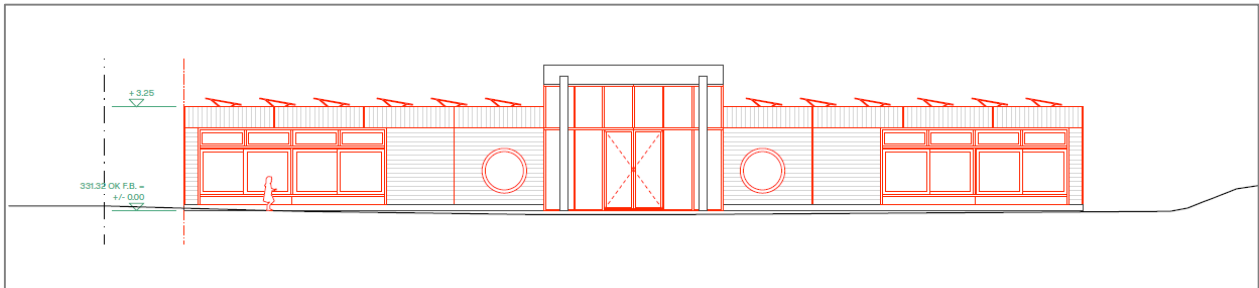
Fassade Doppelkindergarten Schönenbergstrasse
